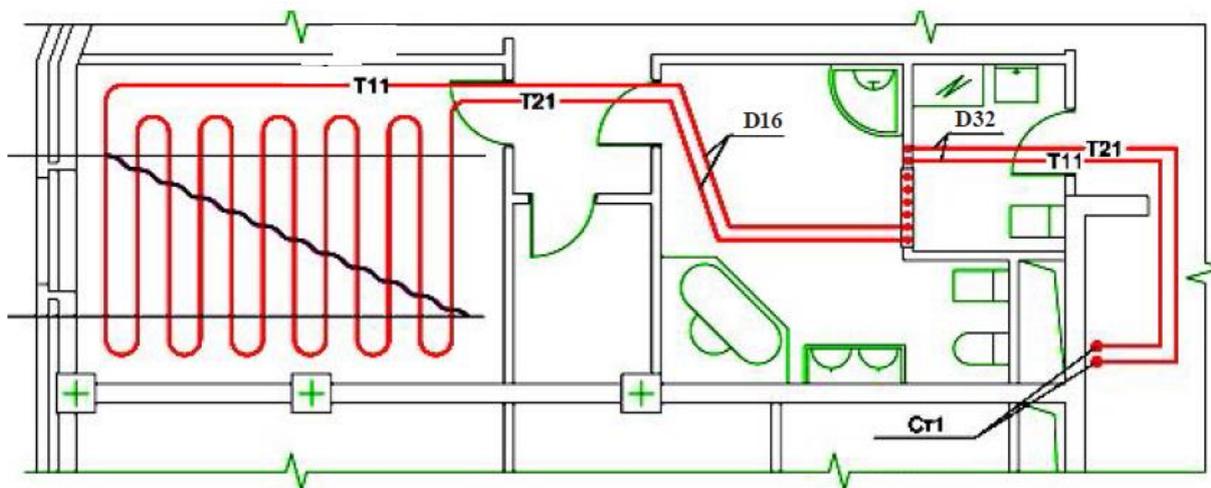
Схема напольного отопления с одиночной укладкой греющих труб
